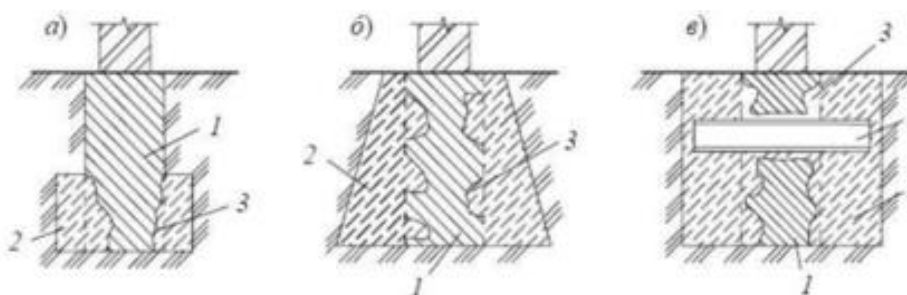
Схемы усиления ленточных фундаментов бетонными обоймами: а – обойма у подошвы; б, в – трапецидальная и прямоугольная обоймы на всю высоту тела фундамента; 1 – фундамент; 2 – обойма; 3 – штрабы; 4 – балка усиления.
